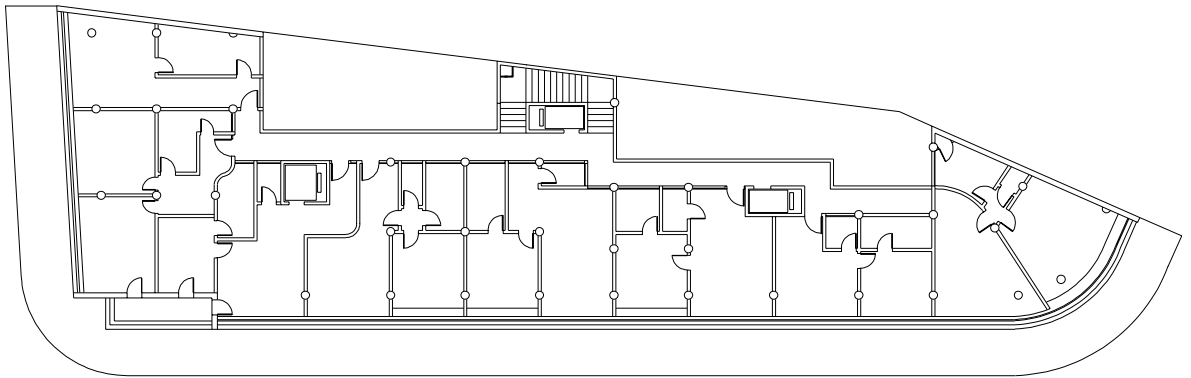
Planta-tipo entre o primeiro e o quarto pavimento do Edifício Arthur Nogueira.
